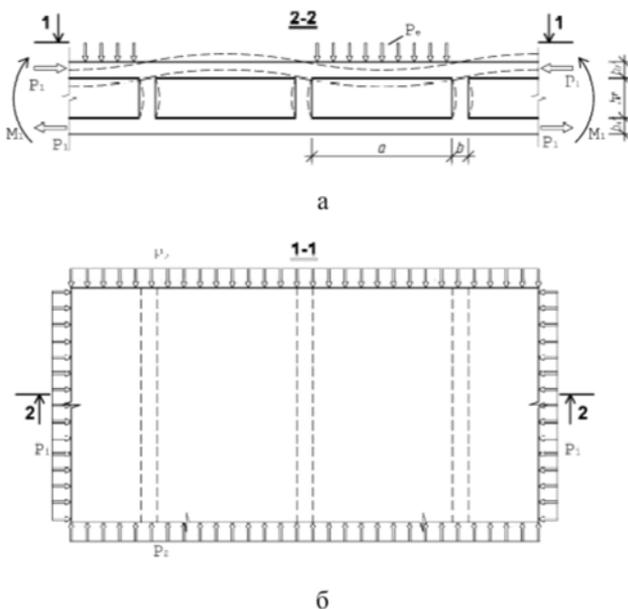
Схема напряженно-деформированного состояния верхней полки перекрытия в сечениях с вставками: а – местное сечение; б – план
